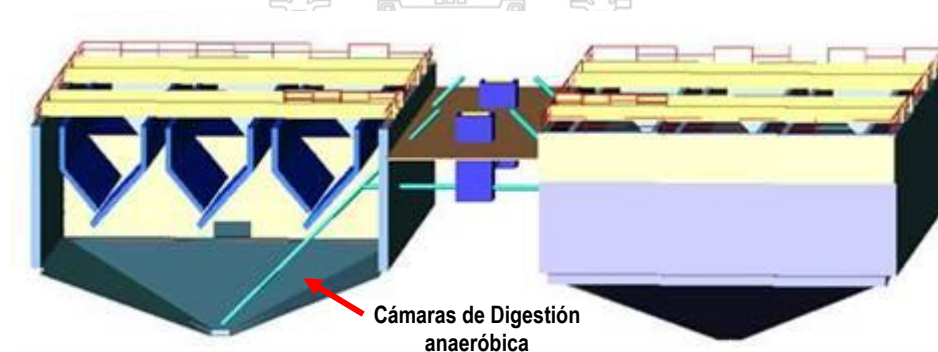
Vista frontal y detalle de las tres cámaras de sedimentación con extremo V abiertas a las cámaras de digestión piramidal invertida del fondo y las tuberías de descarga de lodos.
